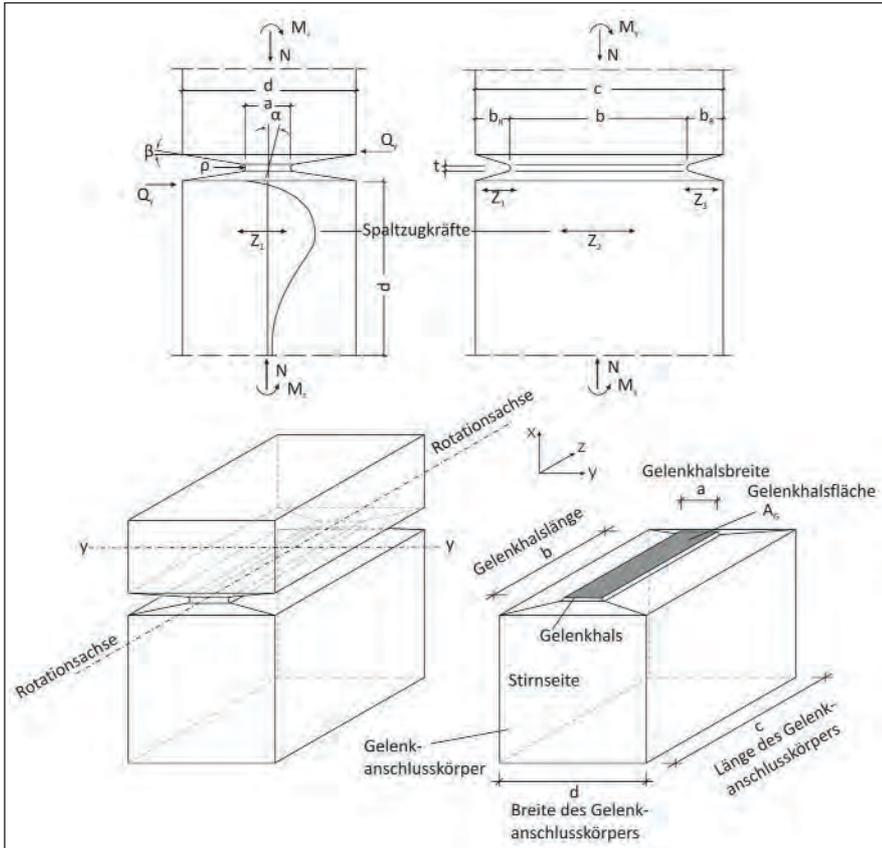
Definitionen und Formelzeichen am Betongelenk (nach [1])
